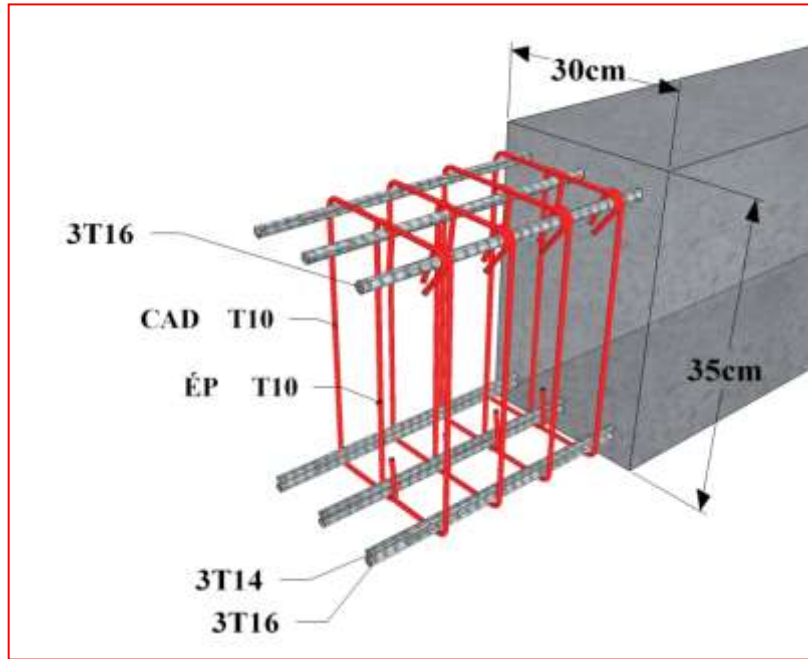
Vue pour le ferrailage de la poutre palière
